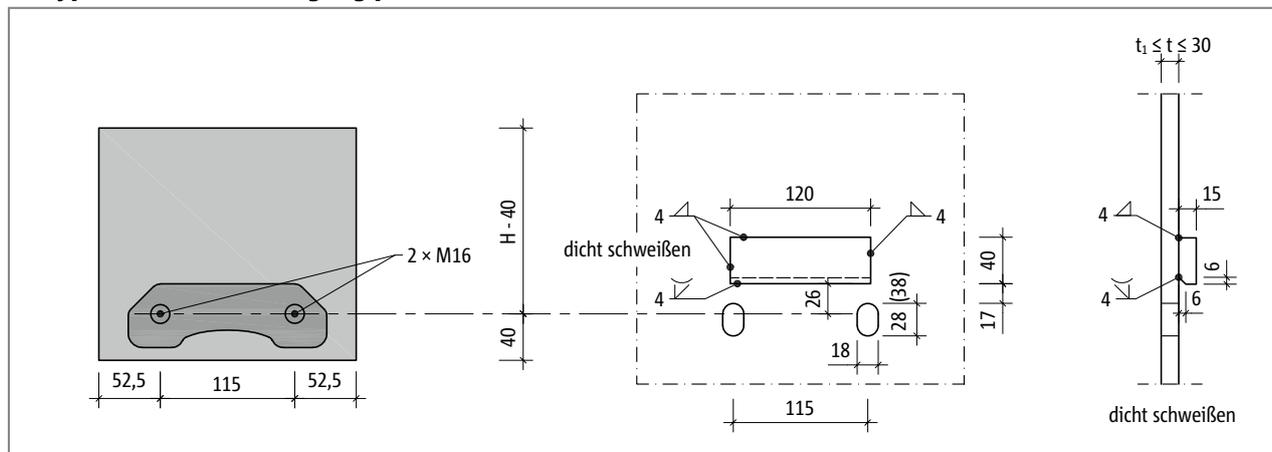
Schöck Isokorb® XT Typ SQ: Konstruktion des Stirnplattenanschlusses
